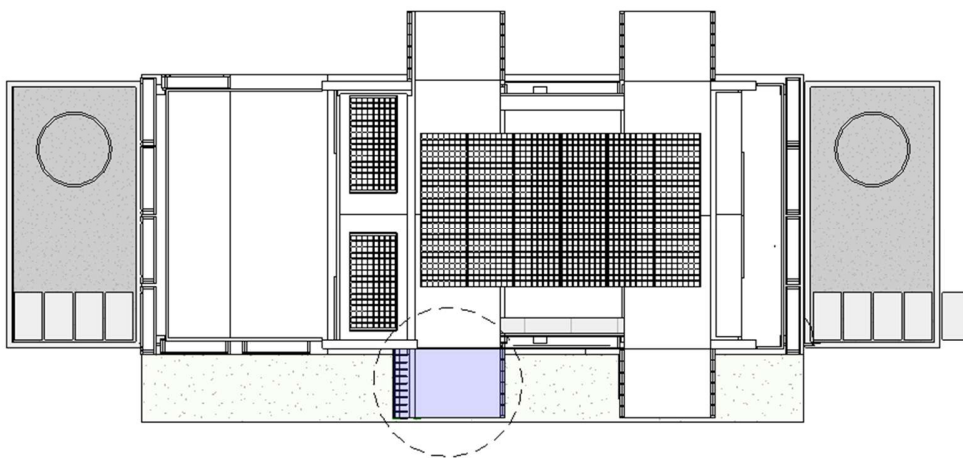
Aplicación de la fachada en planta (Modelo 3D Revit Ecovilla)
